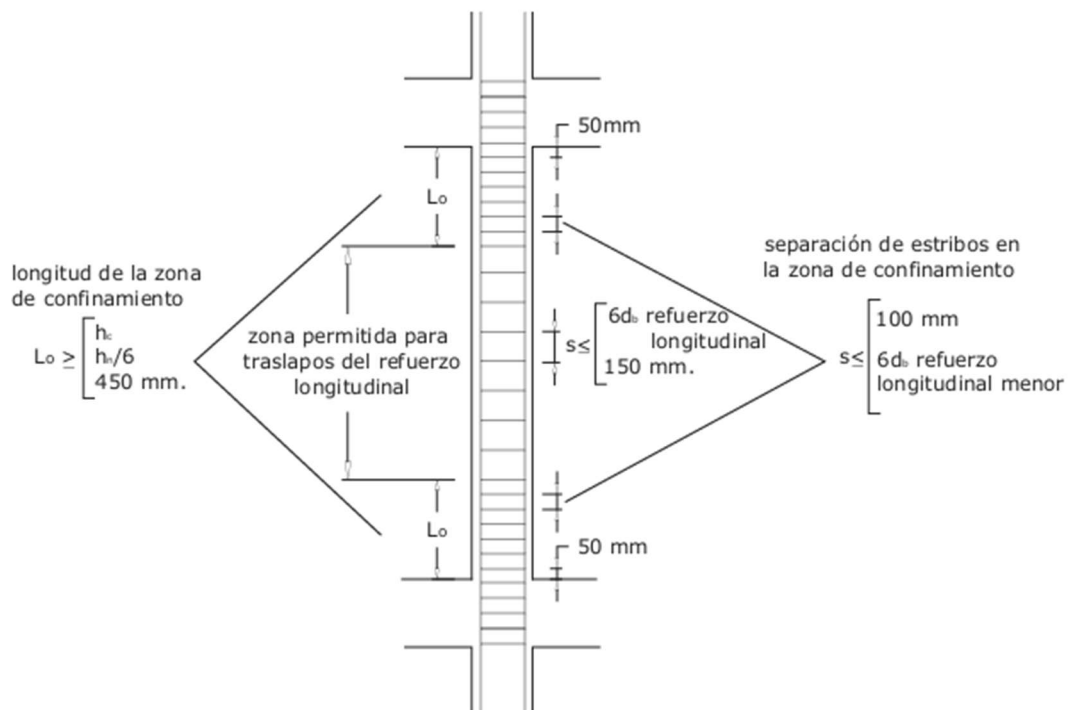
Refuerzo en columnas, (NEC-SE-HM, 2015)
